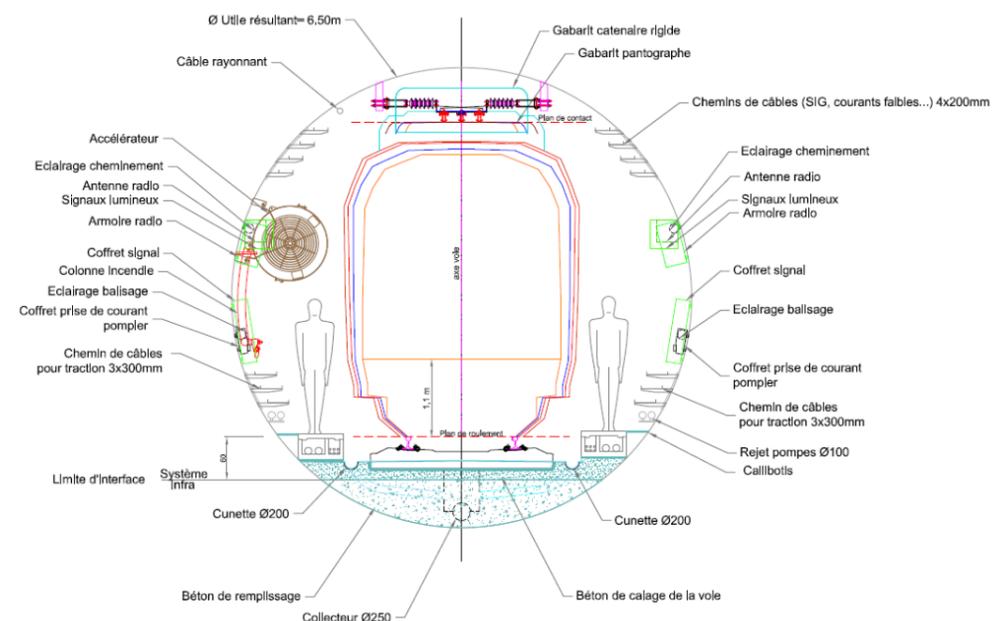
Coupe Tunnel monovoie Ø 6,5 m
